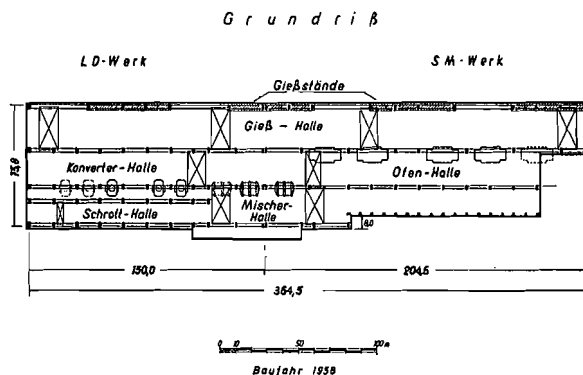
Grundriß der Stahlwerkshalle Rourkela
